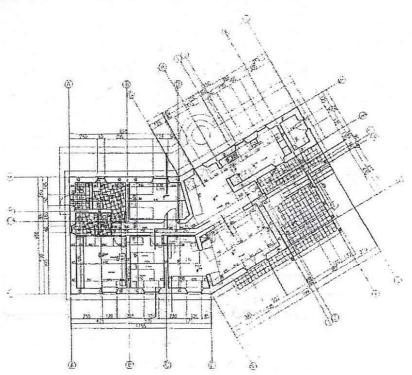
İTÜ-TOKİ 622 yapının planı, 1995 24
